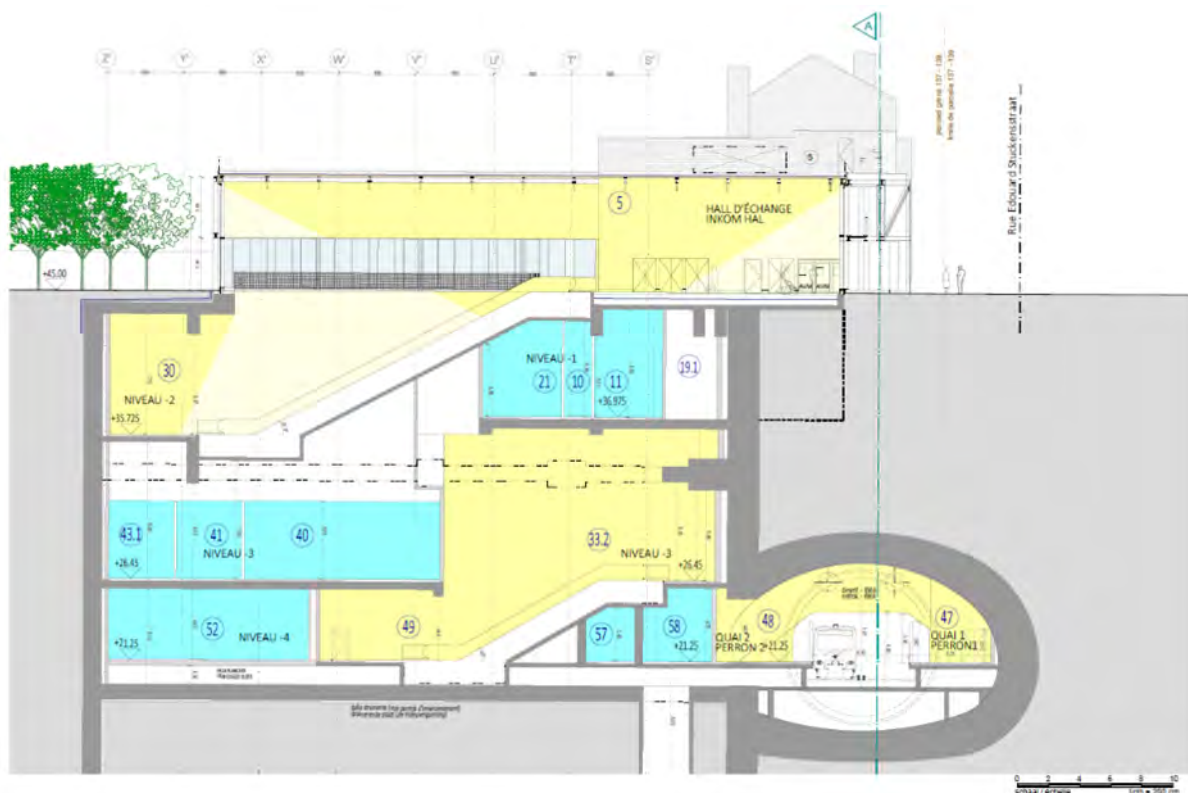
Coupe longitudinale du hall d'échange et des accès aux quais – Station Paix (BMN, 2018)
